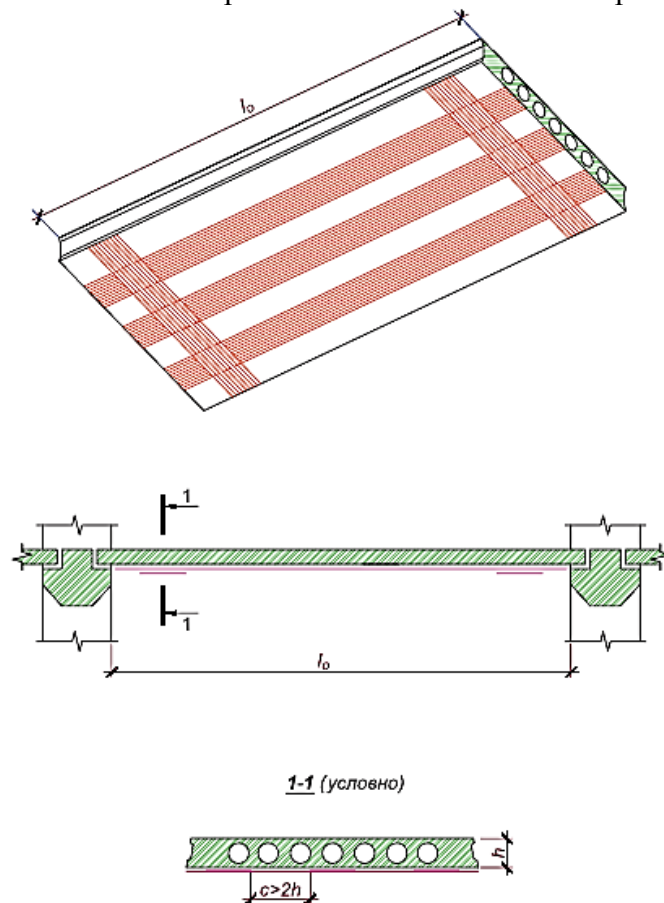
Усиление сборных железобетонных плит перекрытия композитными материалами (ламинатами)
